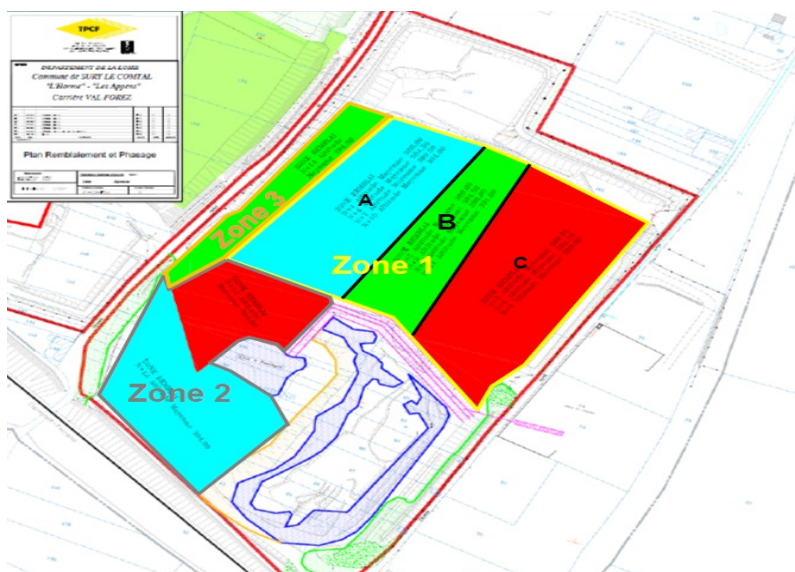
Plan de phasage du remblaiement (Source : TPC)
